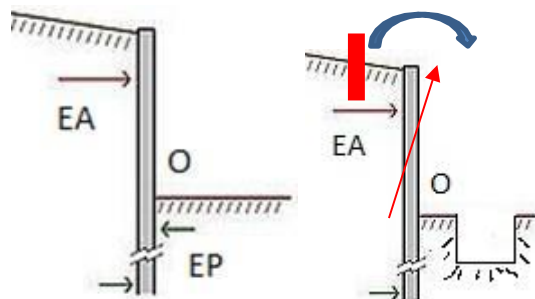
Croqui das forças pré-escavação e pós escavação
